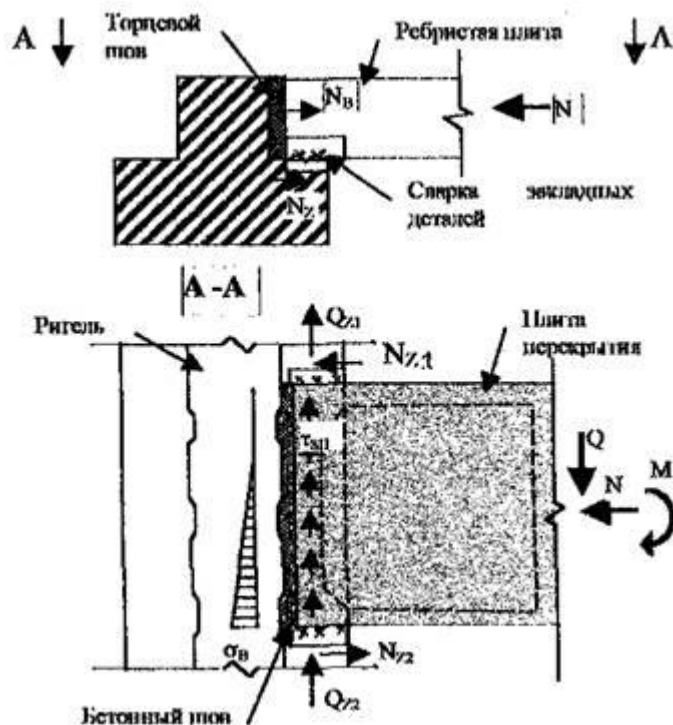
Схема взаимодействия ребристой плиты с ригелем: $\tau_{\text{ш}}$ - касательные напряжения в торцевом шве при сдвиге плиты вдоль ригеля; $Q_{\text{д}}$ и $N_{\text{д}}$ - усилия в сварном соединении плиты с ригелем; $\sigma_{\text{в}}$ - сжимающие напряжения в торцевом шве
